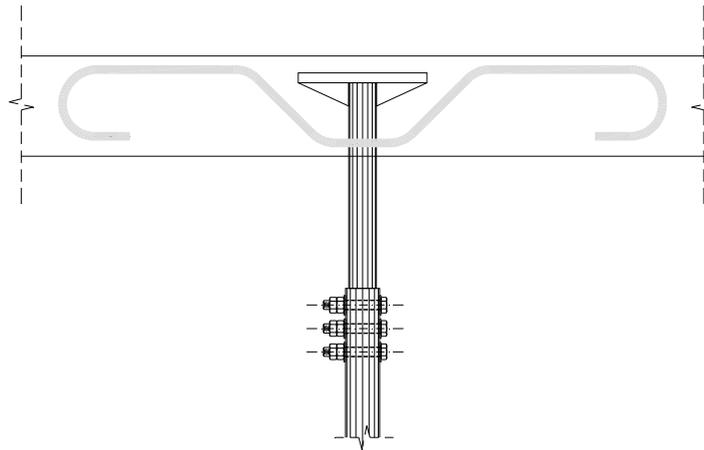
COLLEGAMENTO TUBOLARE Ø101.6X8 ALLA TRAVE IN C.A.
